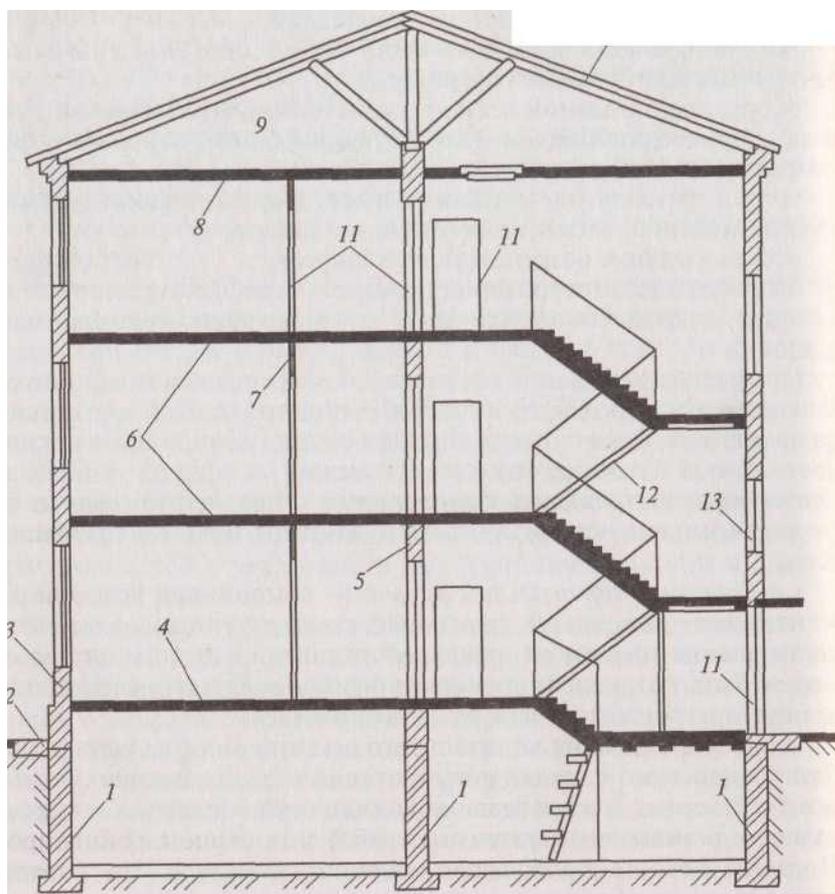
1 – фундаменты; 2 – отмостка; 3 – наружные стены; 4 – надподвальное перекрытие; 5 – внутренние стены; 6 – междуэтажные перекрытия; 7 – перегородка; 8 – чердачное перекрытие; 9 – чердак; 10 – крыша; 11 – двери; 12 – лестница; 13 – окна
